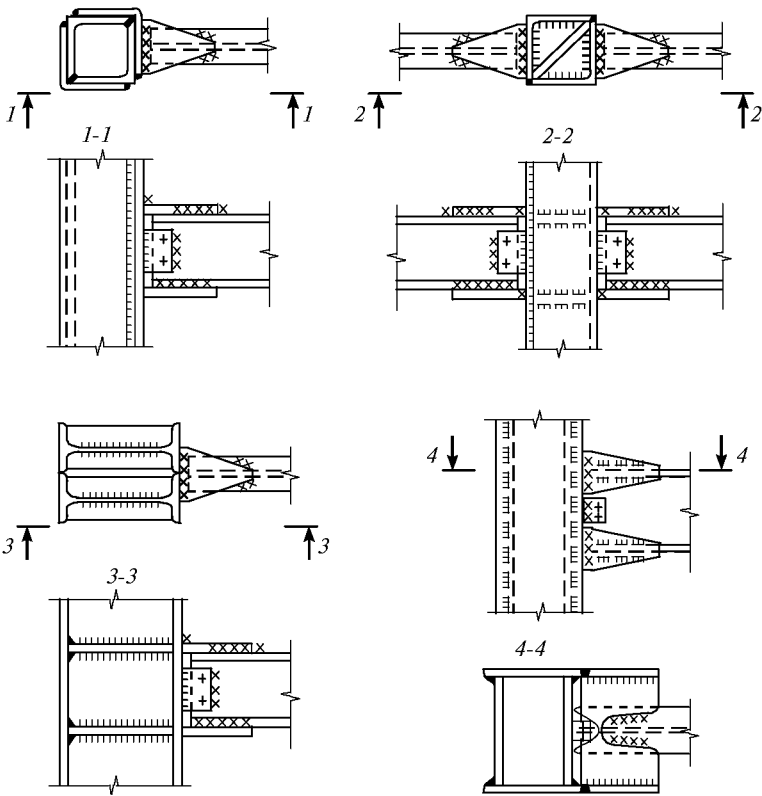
Рамные (жесткие) узлы крепления балок к колоннам замкнутого сечения
